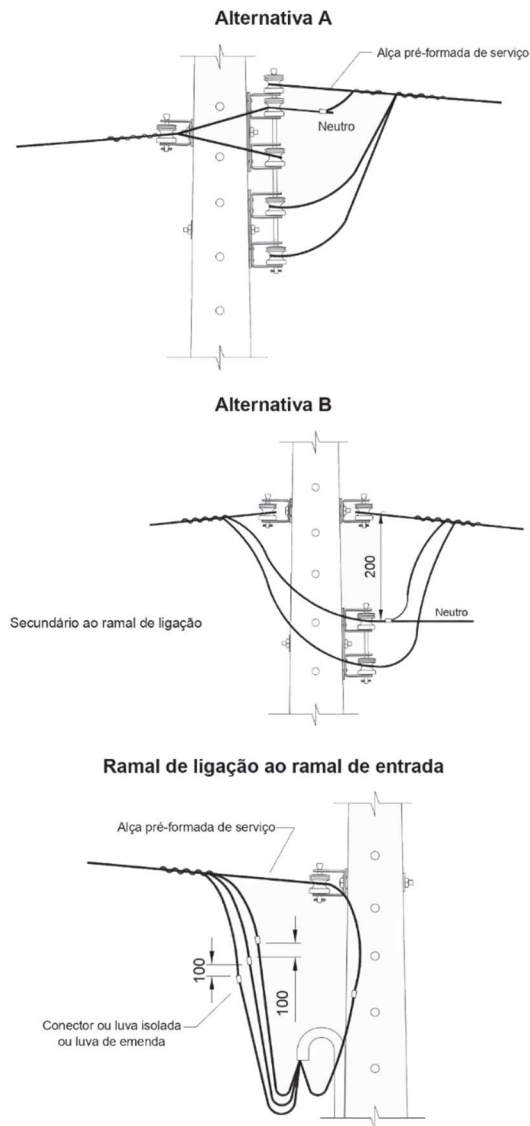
Amarrações e ligações – Secundário - Ligações de consumidores- Poste de concreto de seção DT
